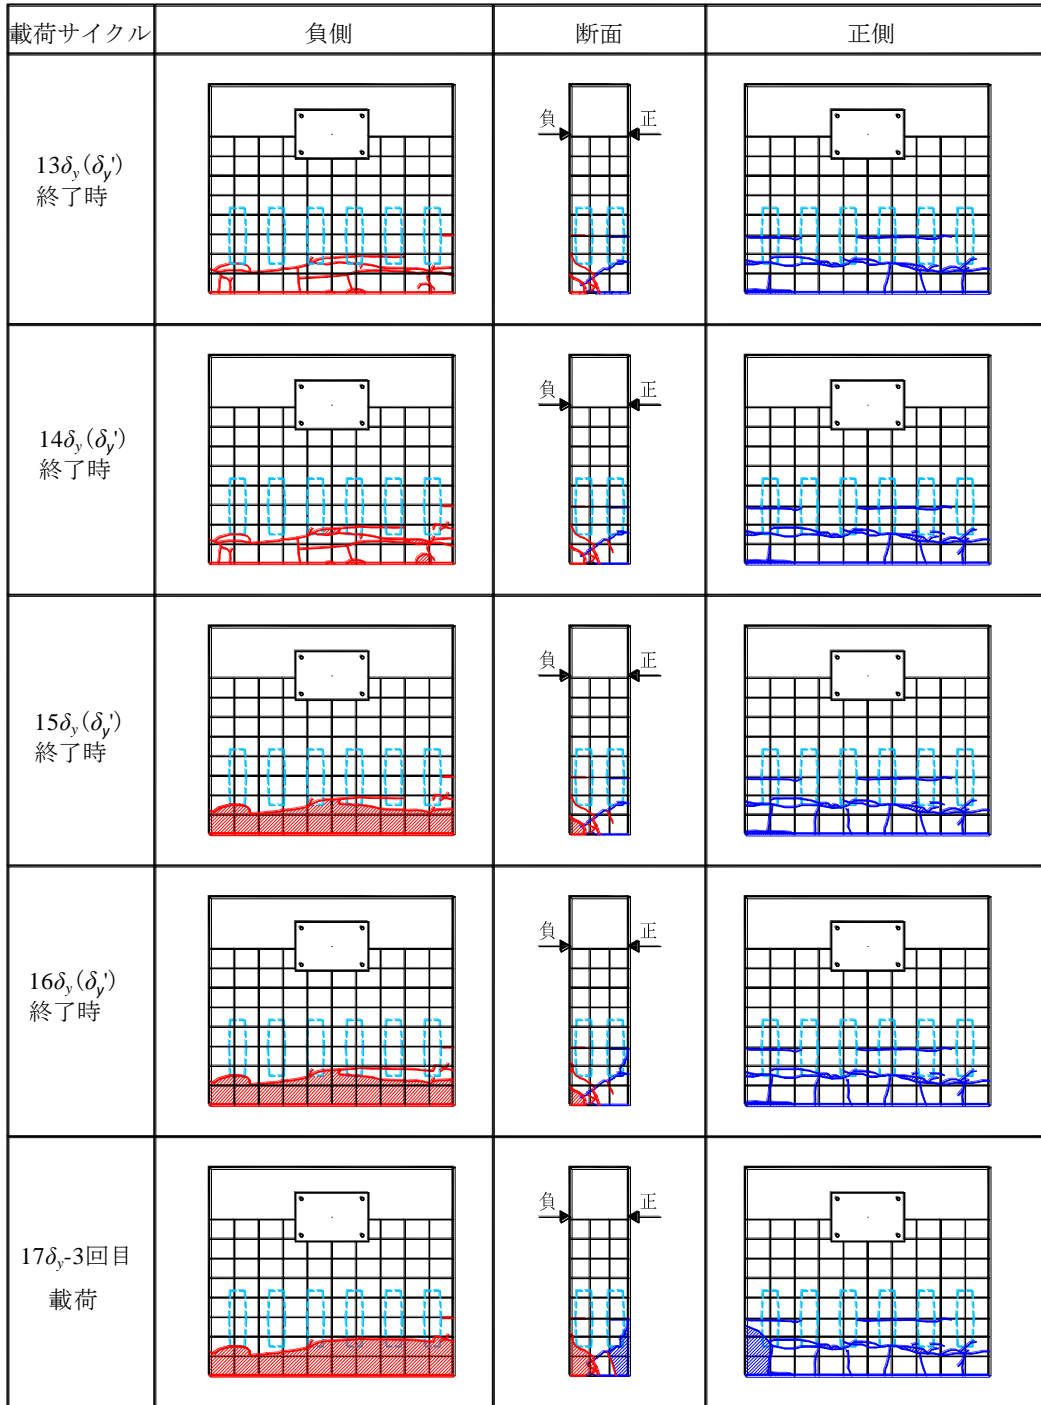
JD13A 試験体ひび割れ図 (13 δ_y ~17 δ_y)
